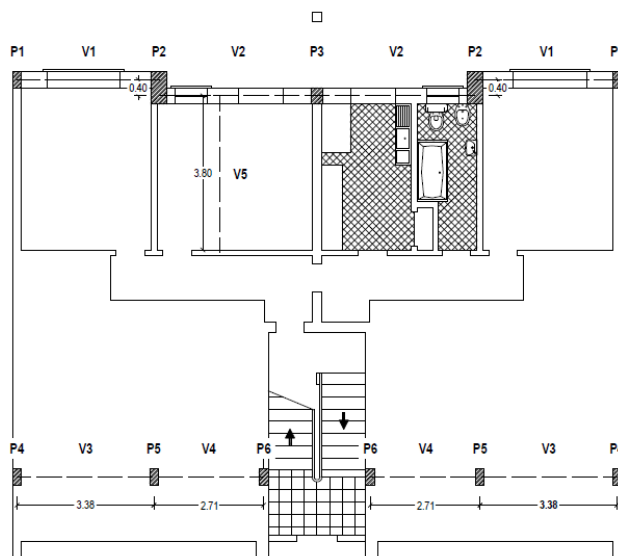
Planta de estabilidade do piso semi-enterrado
